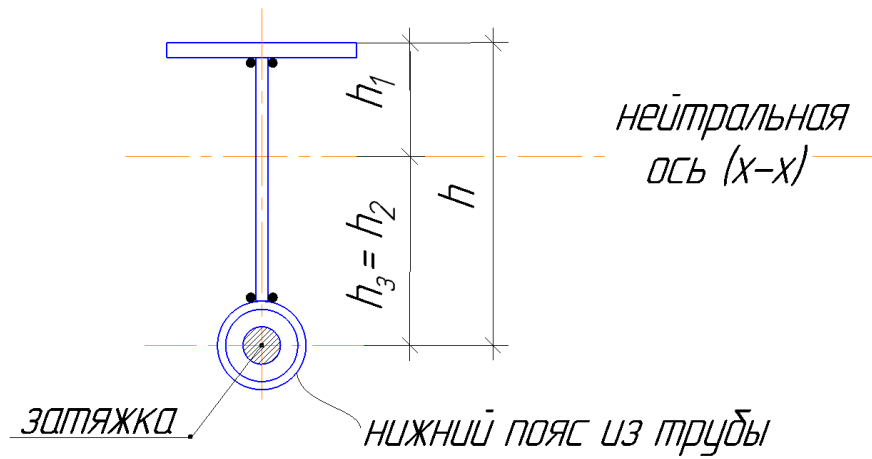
, б. Пример поперечного сечения балки с нижним поясом из трубы
